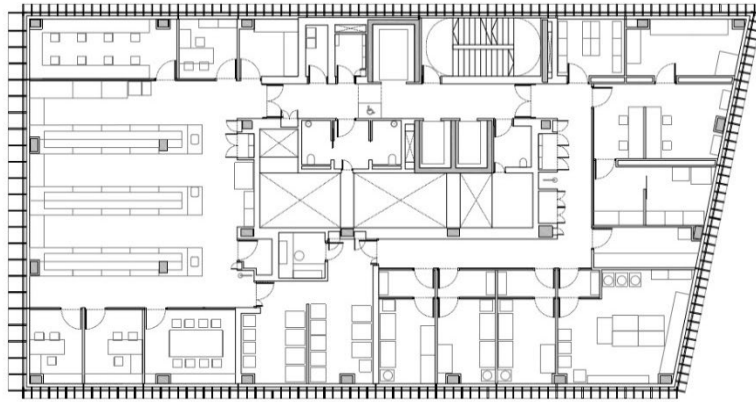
primera planta del edificio de la Sede Instituto BioCruces
